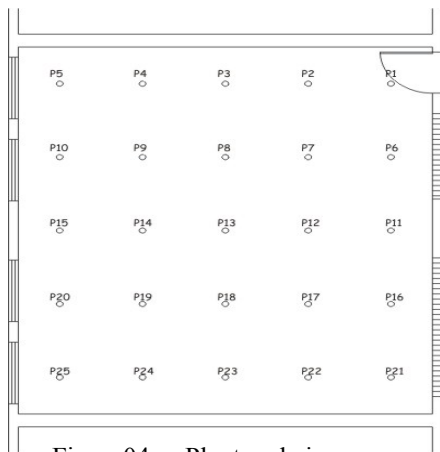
Planta baixa, com respectivas marcações de pontos.
